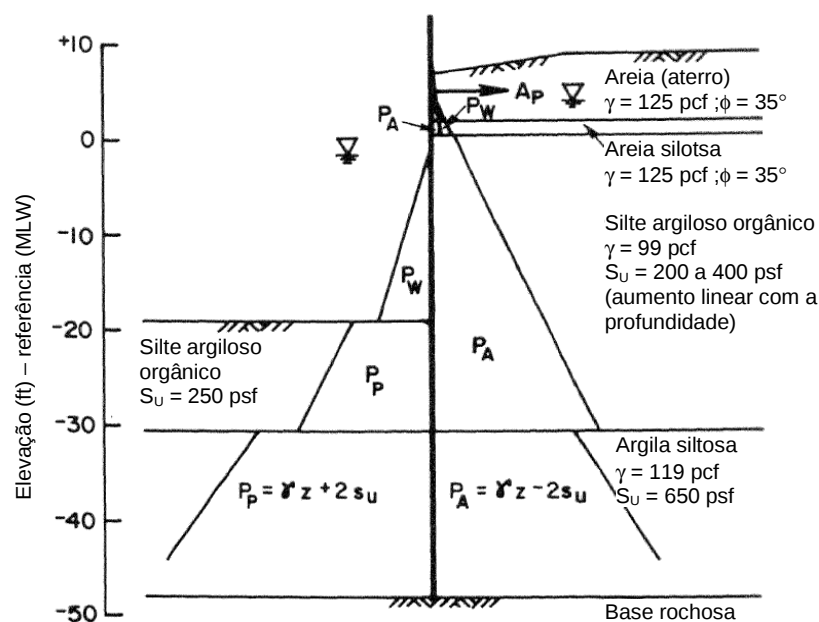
Perfil geotécnico e premissas adotadas nas análises- adaptado de LaGatta e Shields (1984)
